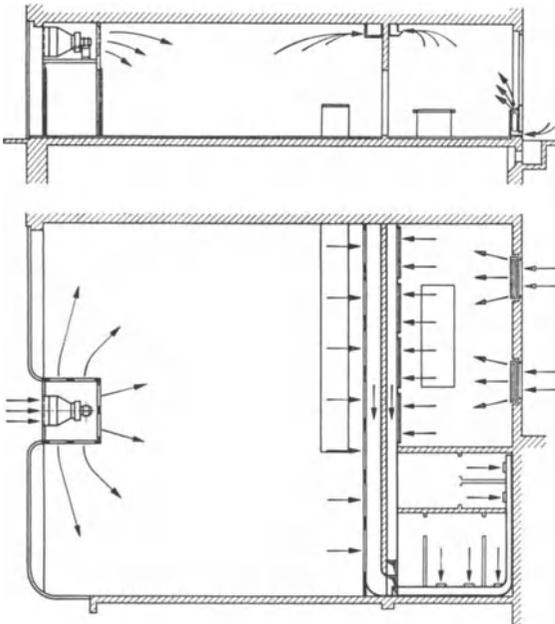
Beispiel für die Lüftung einer Gaststätte mit Küche.
